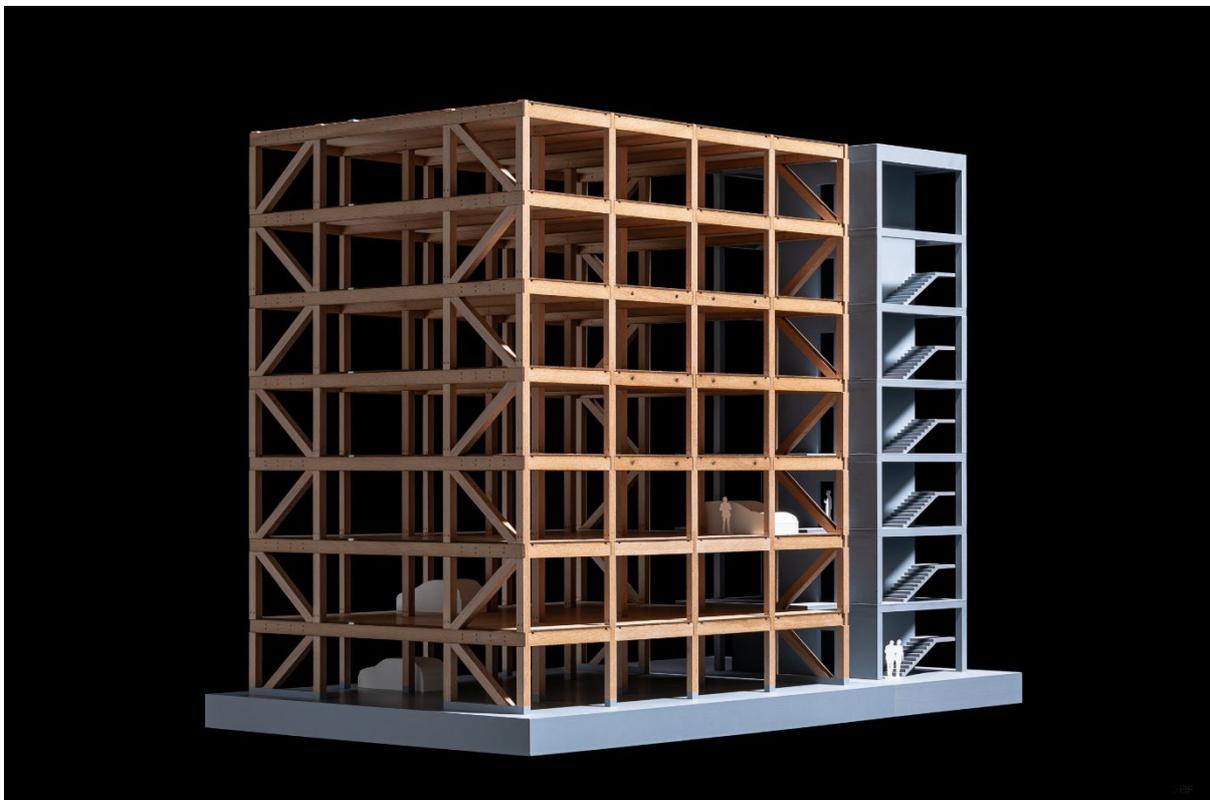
Raumgerüst aus Buchenfurnierschichtholz, t-lab [1]
